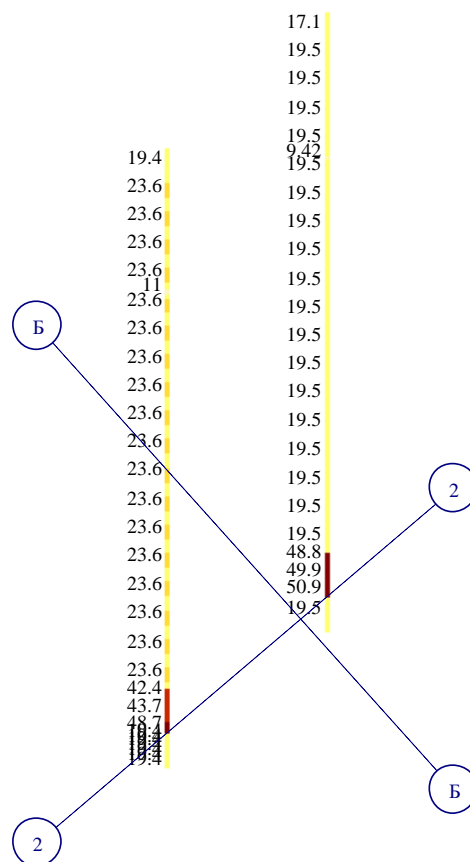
Площадь армирования колонн осях А/2 и Б/2
